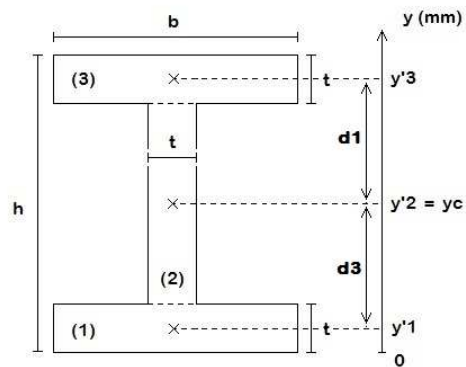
Esquema com a posição dos centros de gravidade do perfil da viga de apoio.
